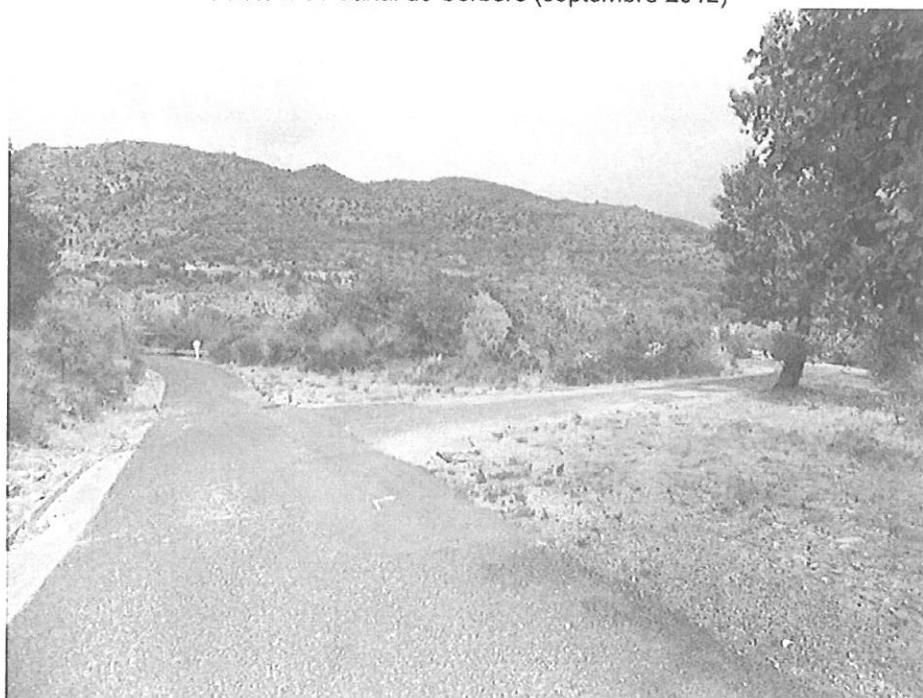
jonction route d'accès au pied du barrage et route d'accès à l'ouvrage brise-charge du canal de Corbère (septembre 2012)
